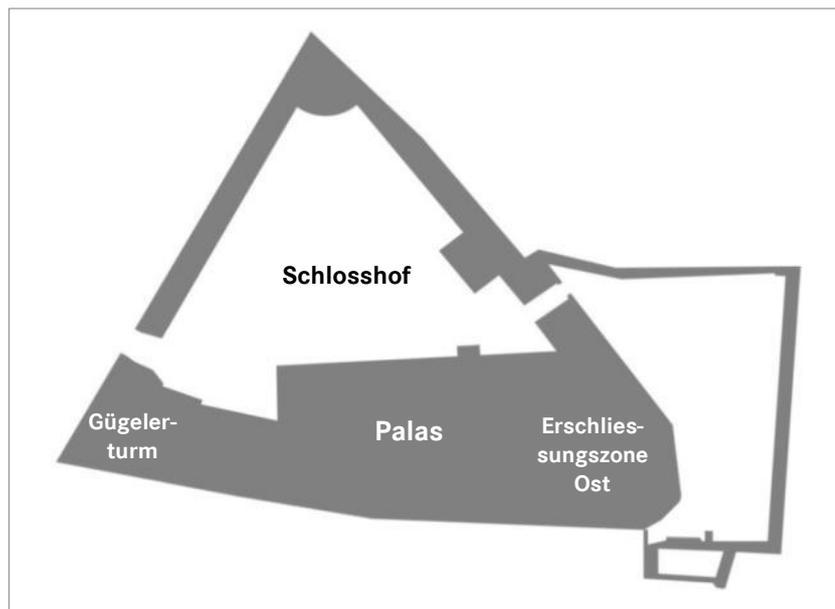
Schloss Rapperswil Übersicht Bauten und Anlagen
